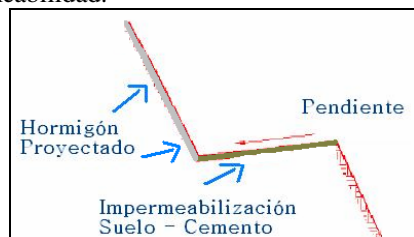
Detalle Impermeabilización Bermas con Suelo – Cemento
